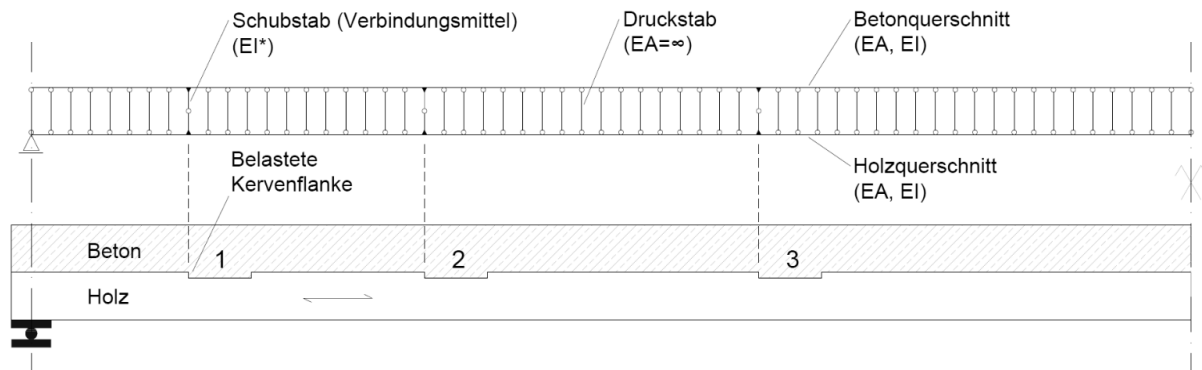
Stabwerkmodell nach Rautenstrauch et al. [16] mit Zeichnung einer HBV-Decke mit Kernen
